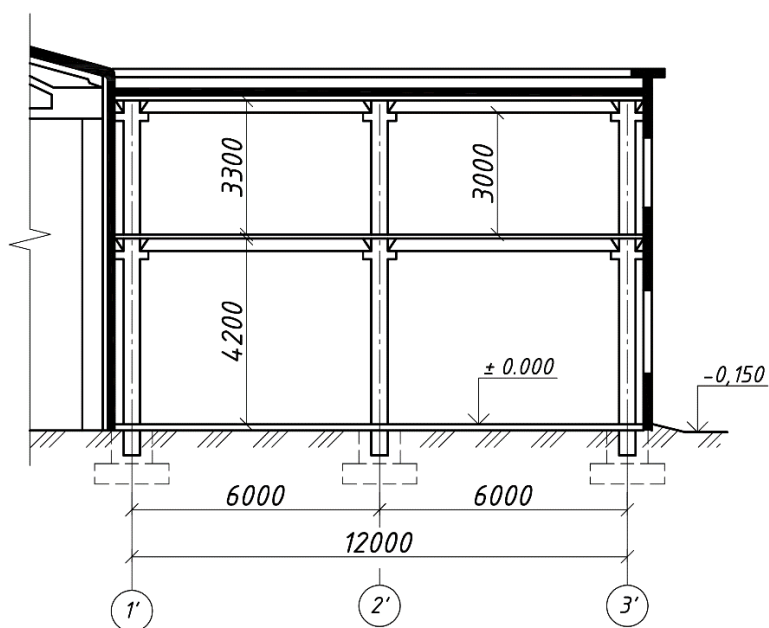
Поперечний розріз прибудови до виробничої будівлі
